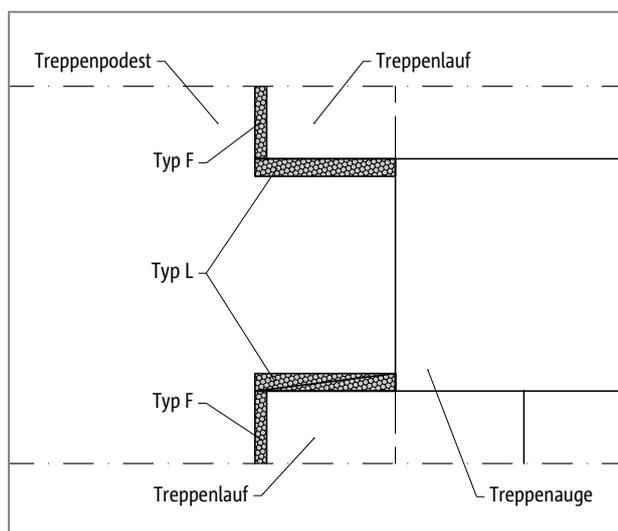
Schöck Tronsole® Typ F: Elementanordnung, Detail A
